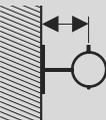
Befestigungsabstände Geberit Mepla Systemrohre ML (Rolle) auf der Rohbetondecke
